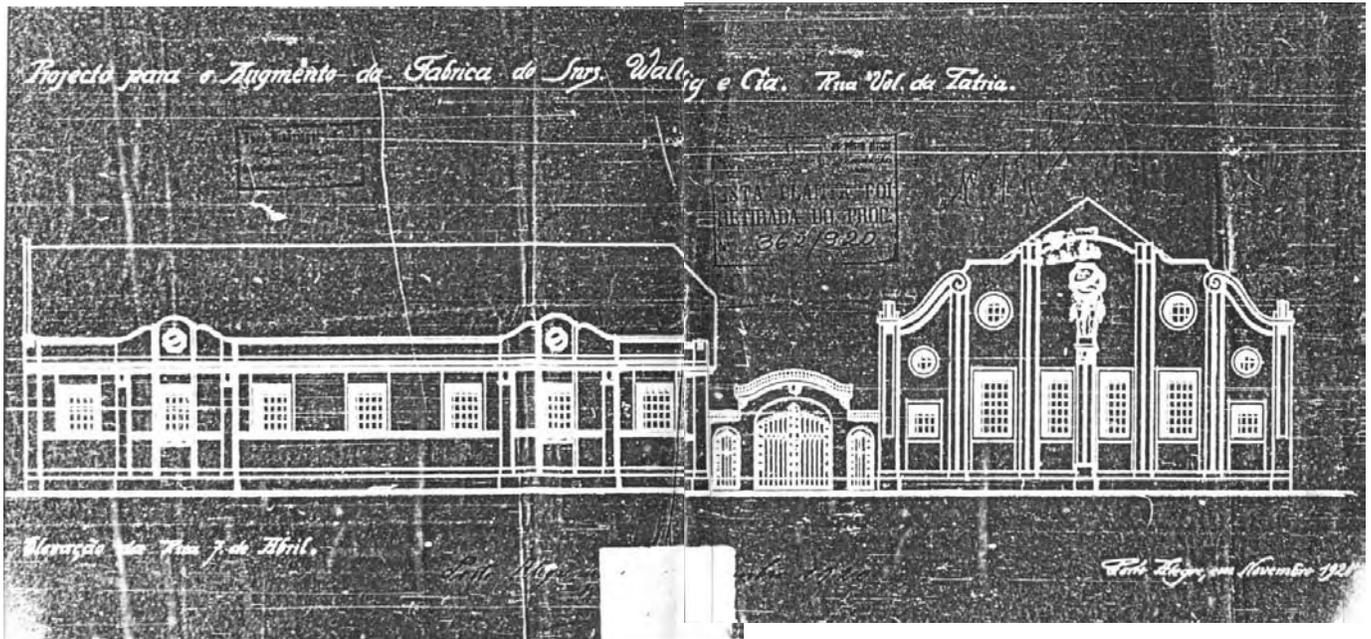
Fachada da Wallig na Rua 7 de Abril.
